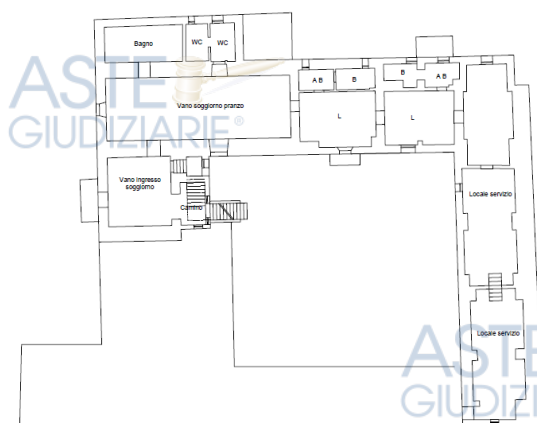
Planimetria rilevata del primo piano della masseria con indicazione delle destinazioni d'uso di progetto (non in scala)
